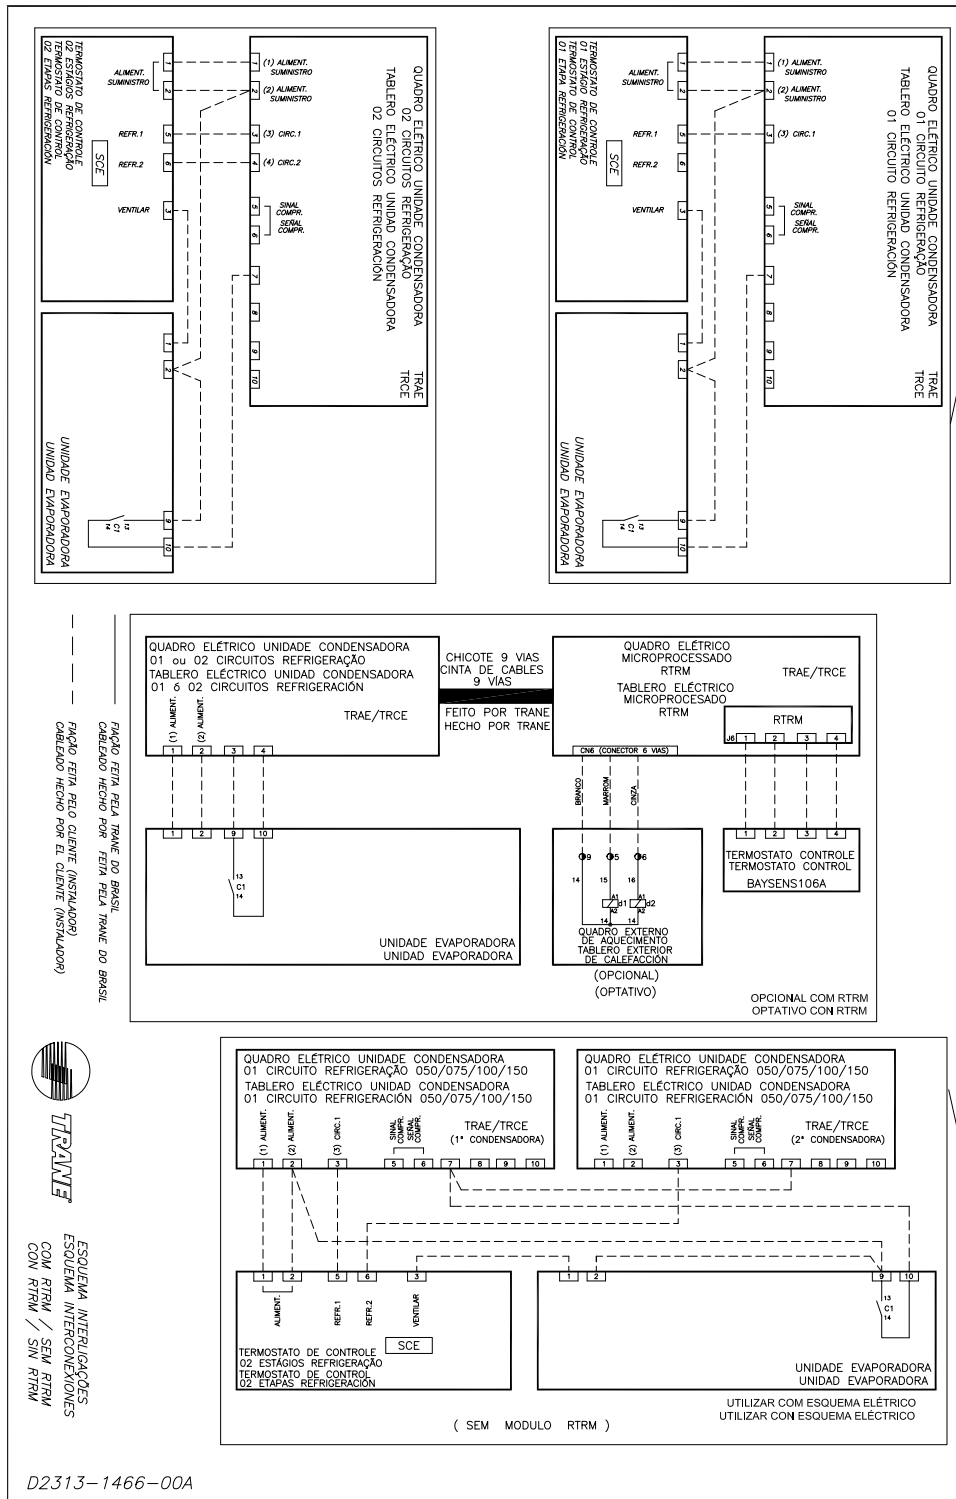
Lay Out de Tableros Eléctricos - TRCE (Estándar/RTRM)
